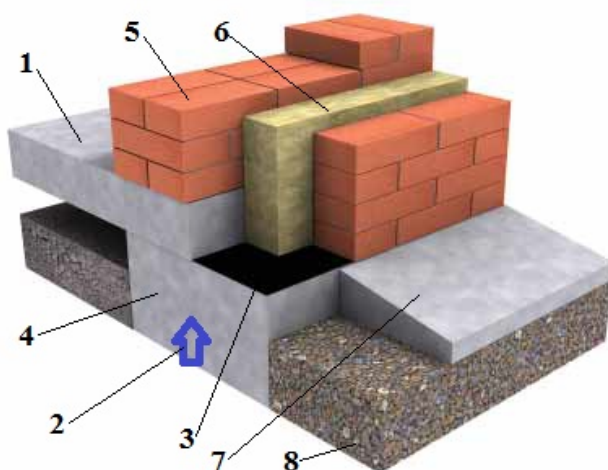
Устройство горизонтальной отсечки влаги: 1 — плита перекрытия; 2 — капиллярный подсос влаги; 3 — гидроизоляция; 4 — фундамент; 5 — стена; 6 — утеплитель; 7 — отмостка; 8 — грунт
